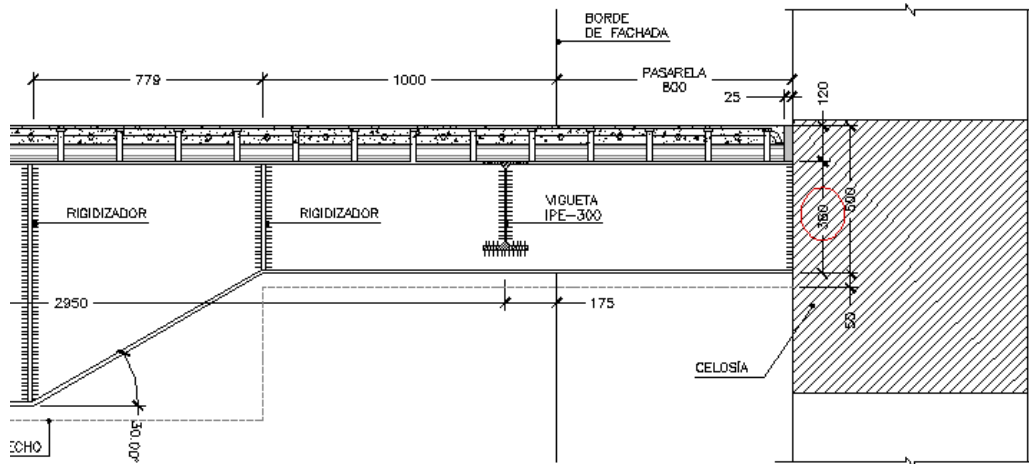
Detalle de encuentro de celosía exterior con fachada.
